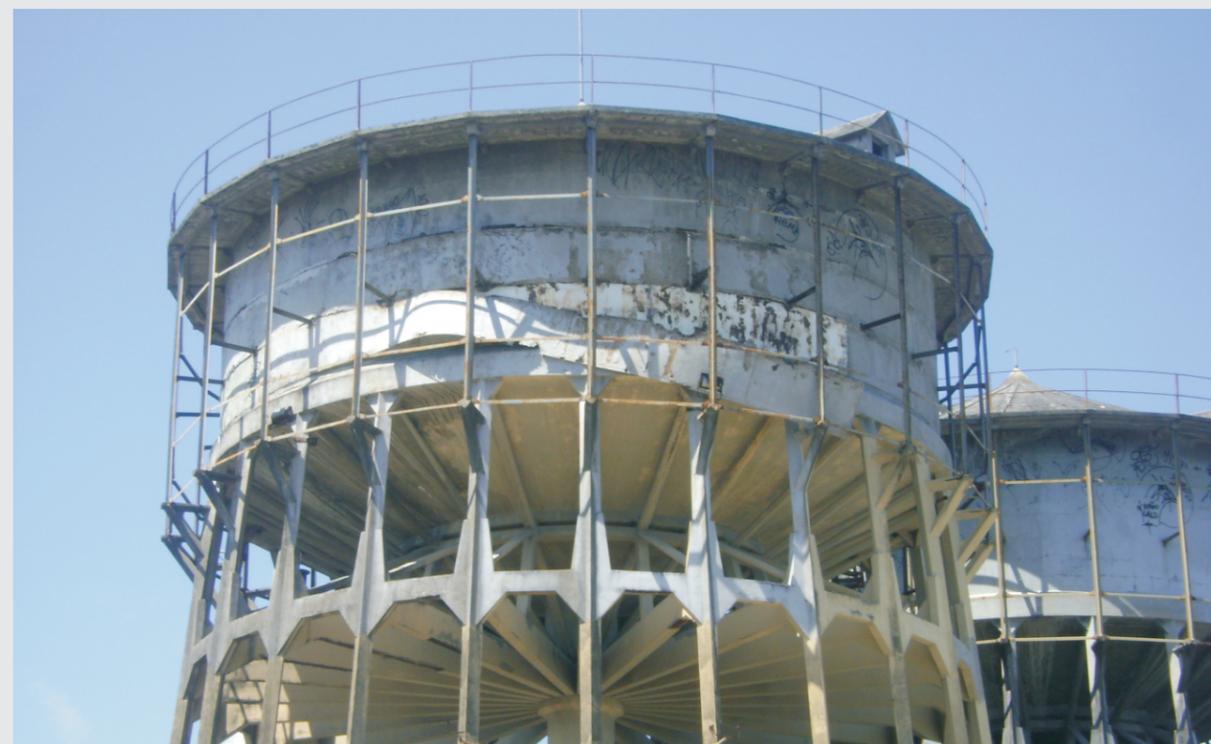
Detalhe da chapa metálica com capa de concreto que está soltando da estrutura.
